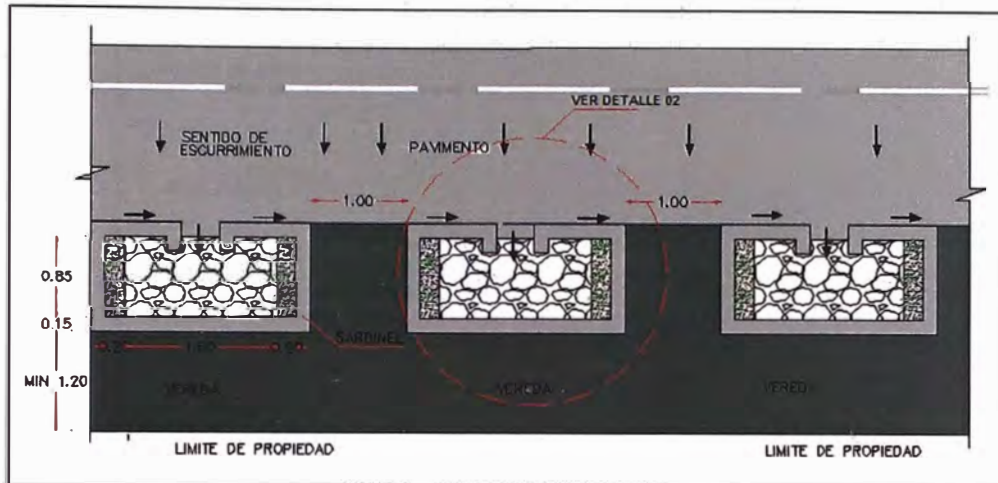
Vista en planta de las trincheras de infiltración típica
